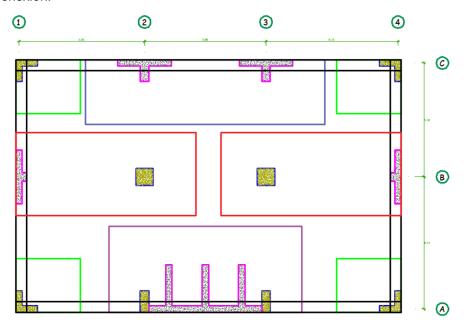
Áreas de contacto para la alternativa de zapatas aisladas.
